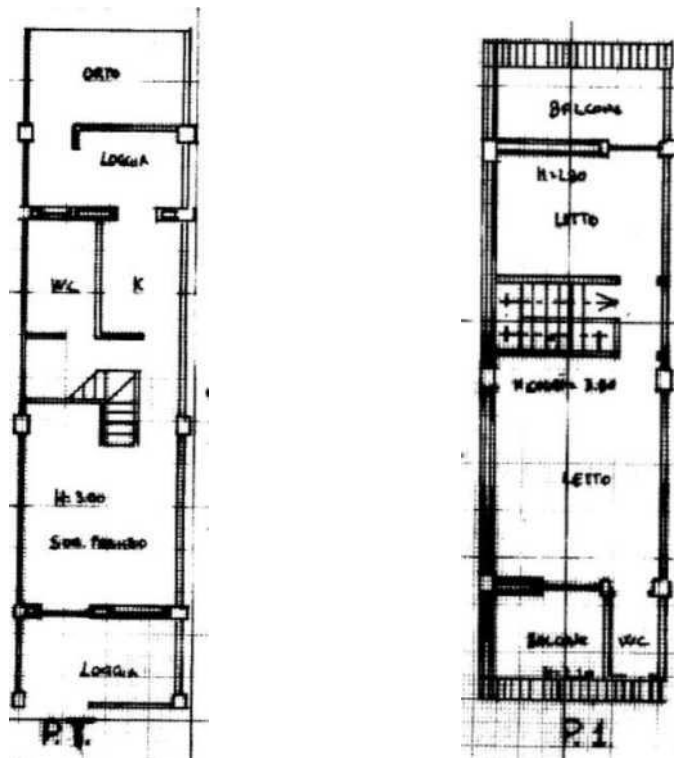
Planimetria catastale dell'appartamento sub 2 (piano terra e piano primo).
